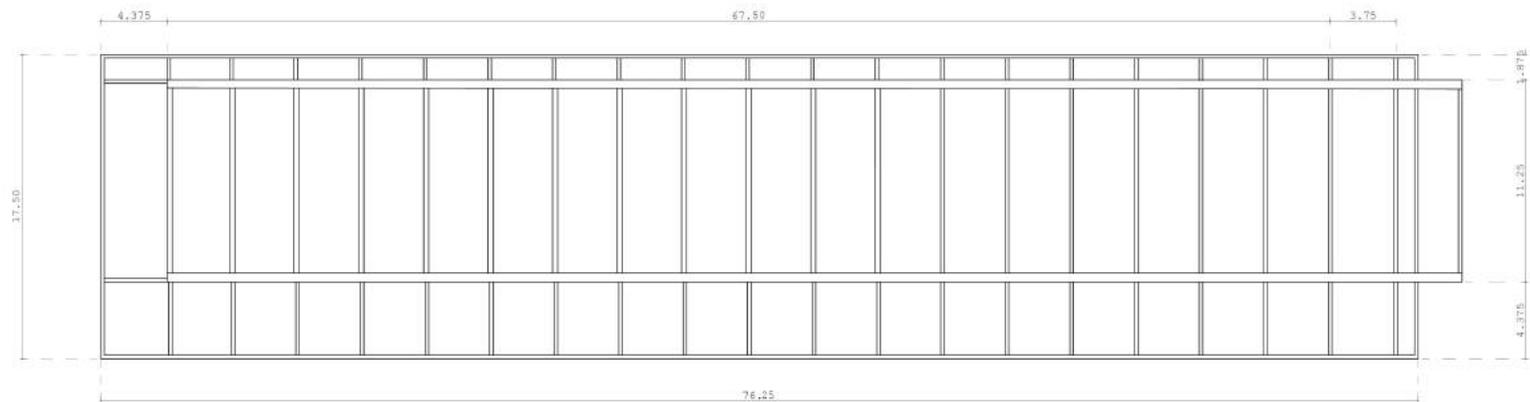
Projeto Estrutural - Vista Serviç o Para so dos Inglese
